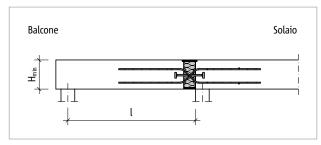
Schöck Isokorb® T tipo QP-VV: sistema statico
